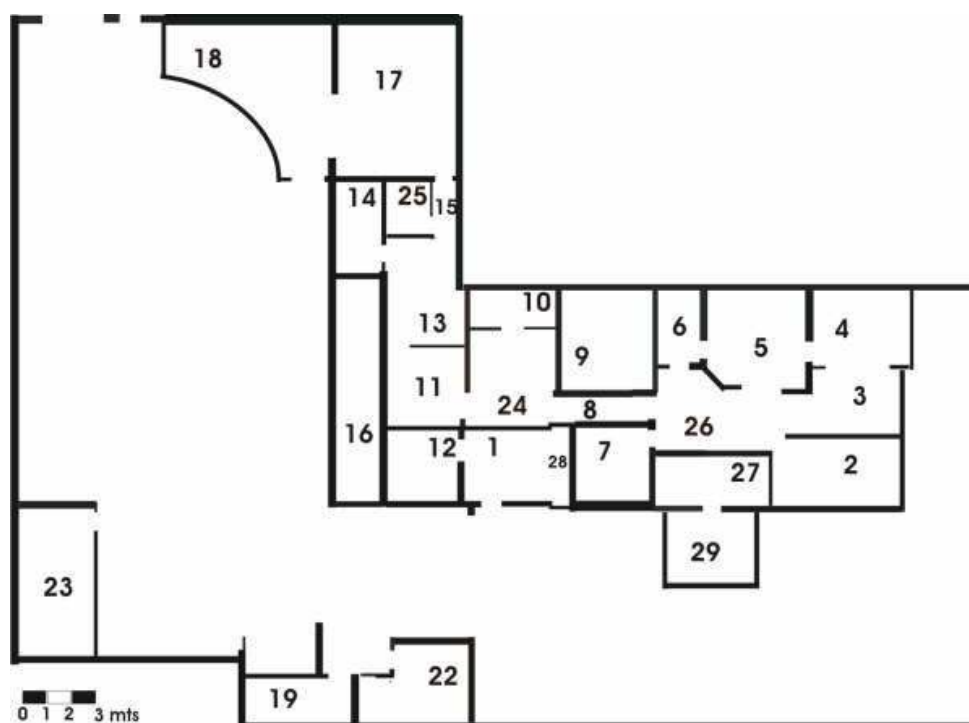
Planta Baja. Plano tomado del anteproyecto de la Fuerza Aérea.
